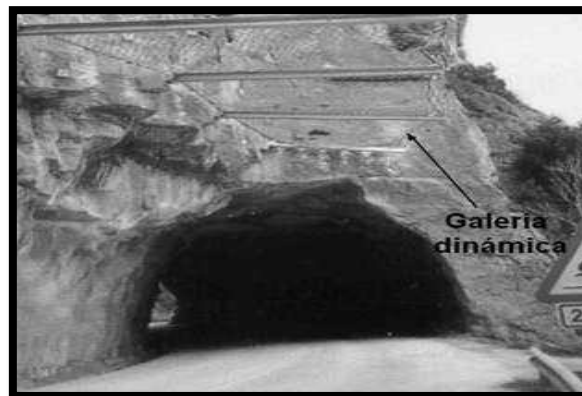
Galería dinámica instalada en la vía Montserrat-Barcelona, España.
